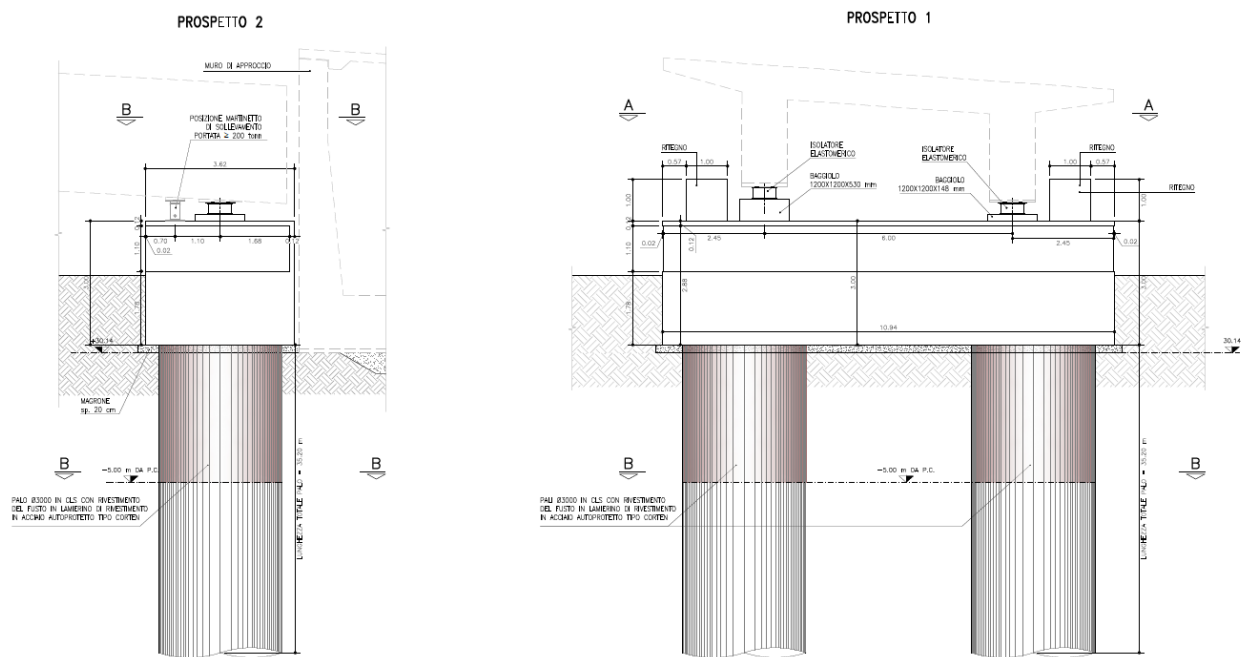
5: Sezione trasversale su spalla Est
